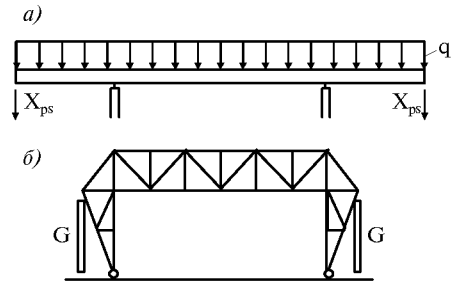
Пригруз (X_{ps}) на консолях и подвеска стен к раме
